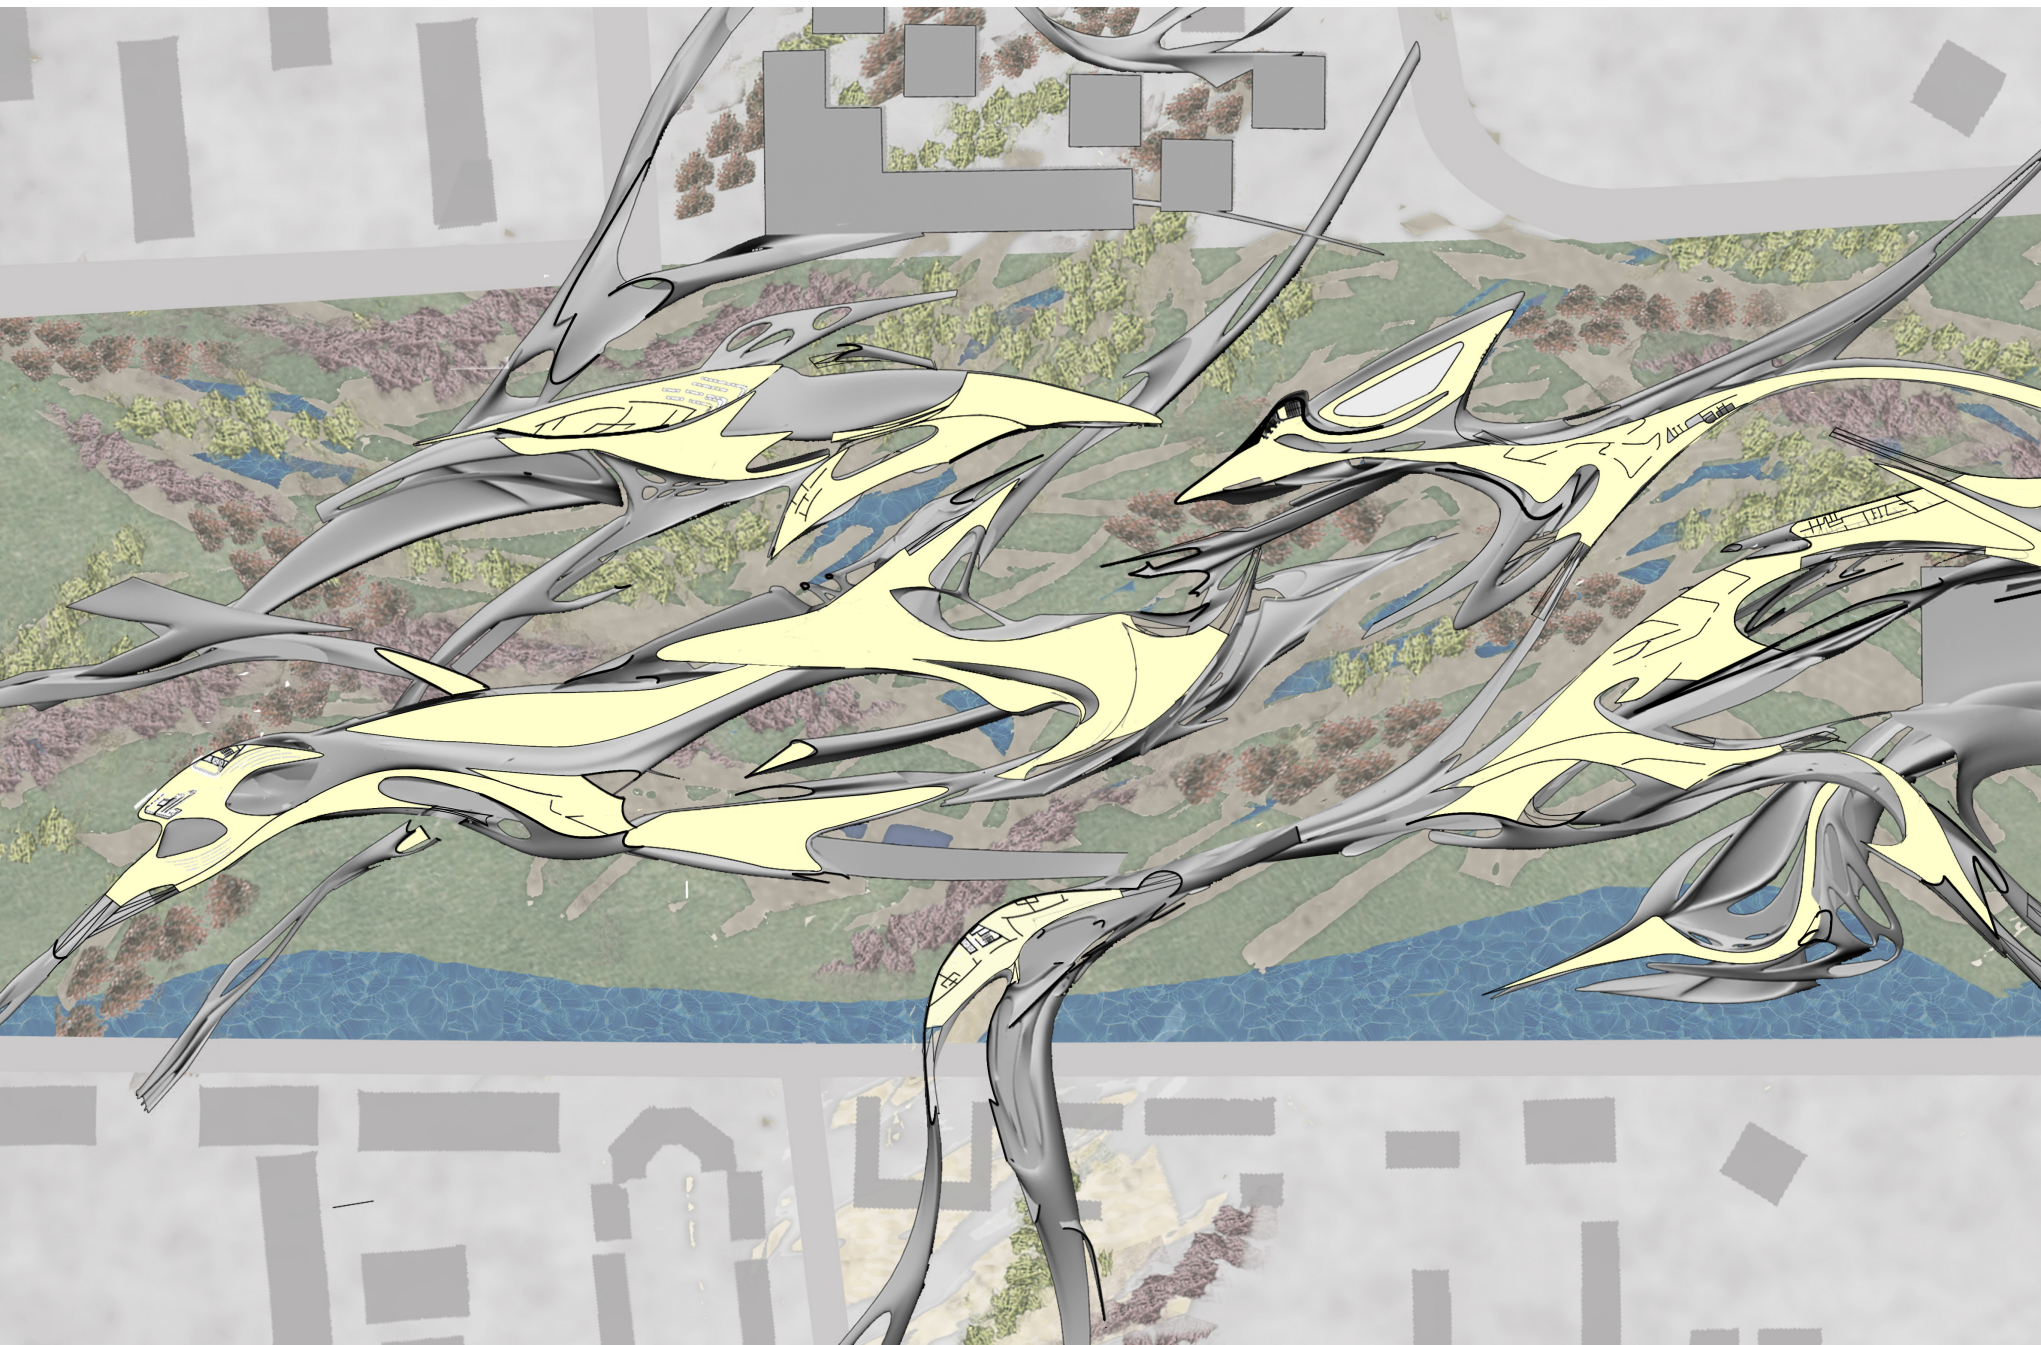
Sviluppo planimetrico della componente attività/attività-attività/spazio- Pianta del piano secondo in scala 1:500
